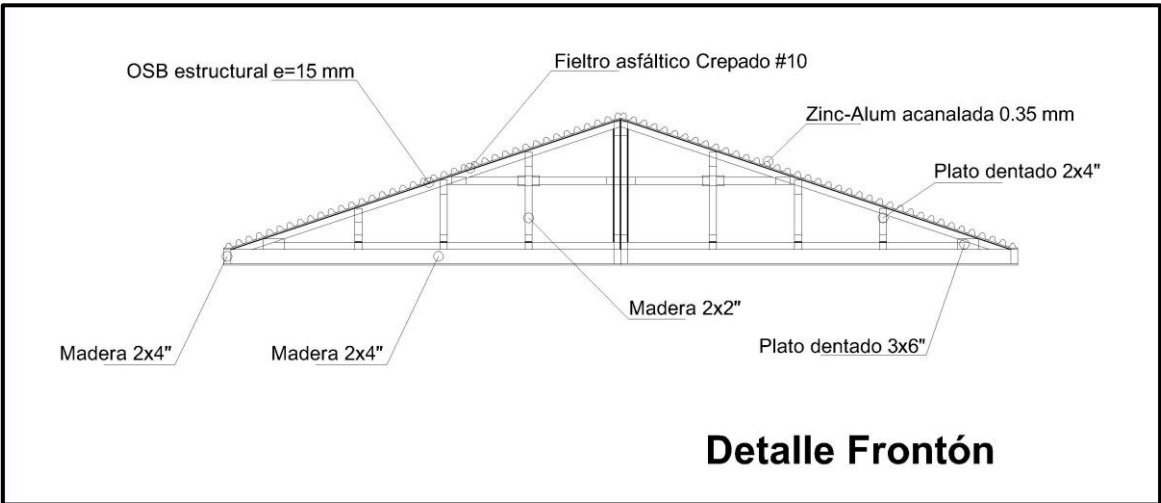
Plano dimensiones frontón. Elaboración propia.
